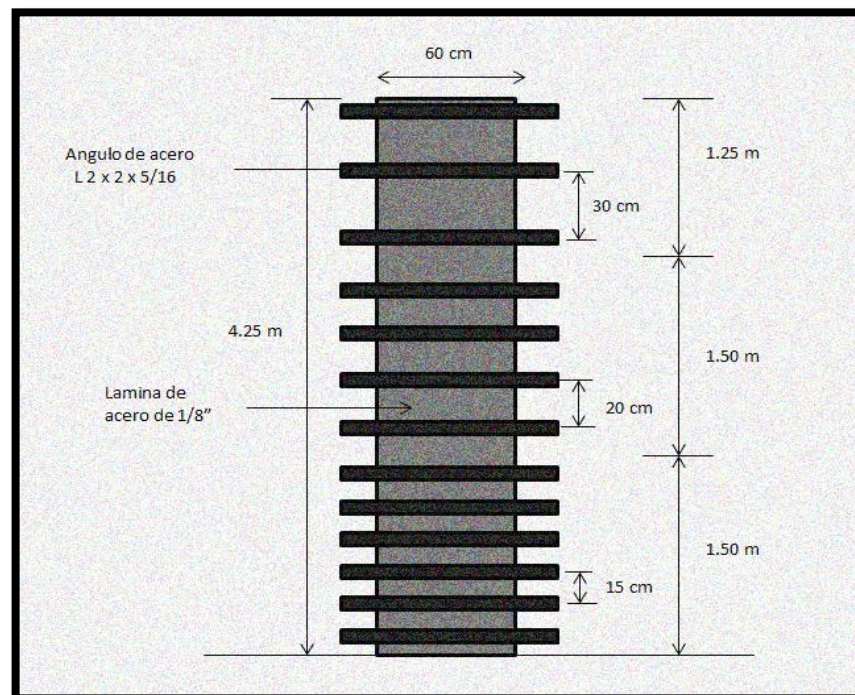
Encofrado metálico para columnas. (Elaboración propia).
